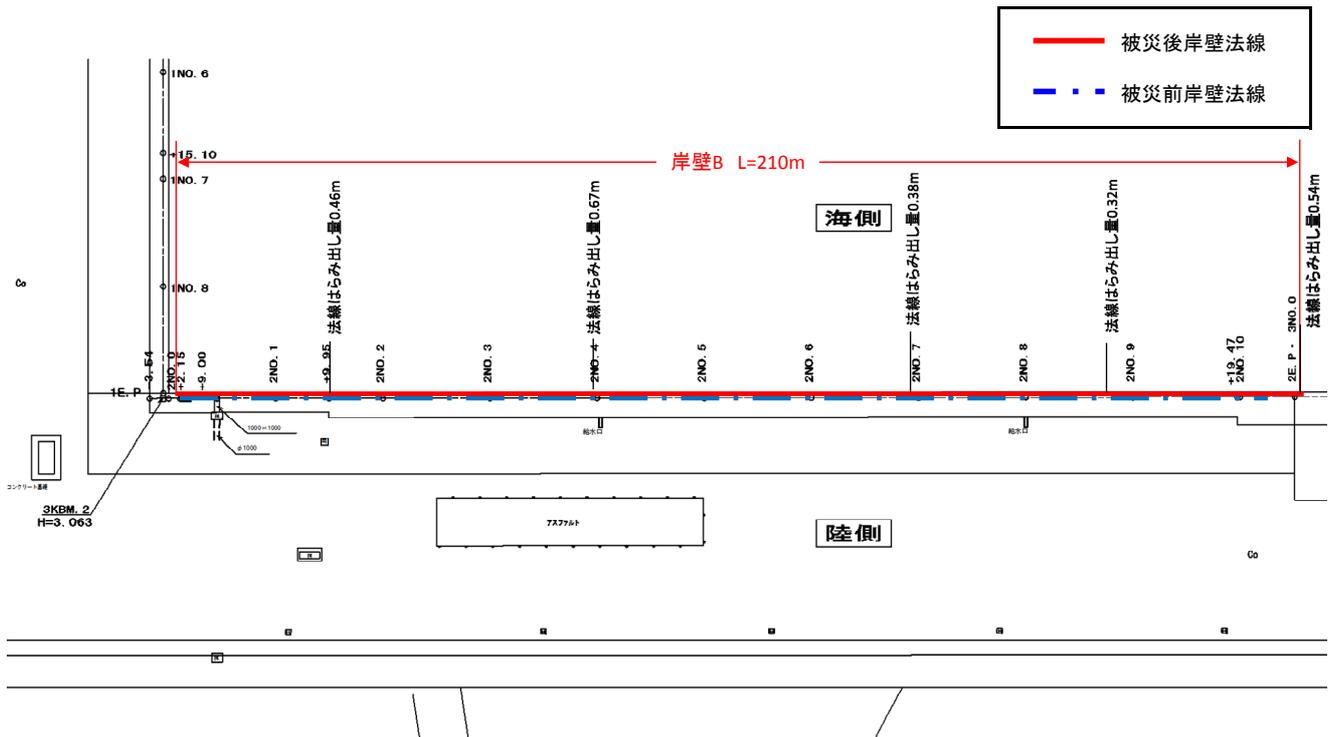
No.22 常陸那珂港区_南埠頭地区 B岸壁 (-5.5m) の平面図 (被災後)
